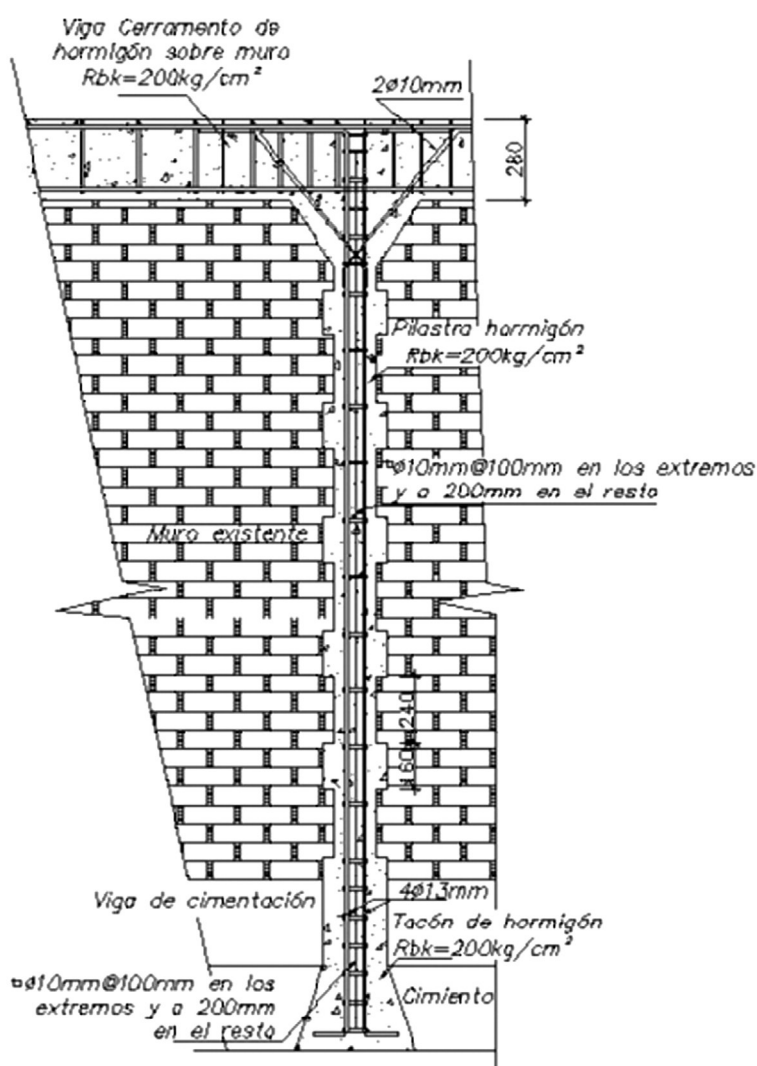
CORTE TRANSVERSAL DE LA COLUMNA Y VIGA DE CERRAMENTO PLANTEADA COMO SOLUCIÓN NECESARIA.
